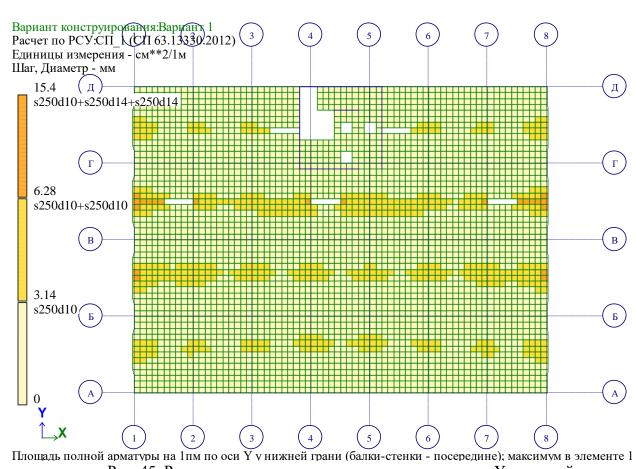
Расчетное армирование плиты покрытия по оси Y у нижней грани.
